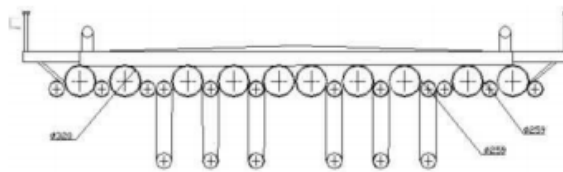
Балочная конструкция со шпренгелями в виде ферм из стальных труб
